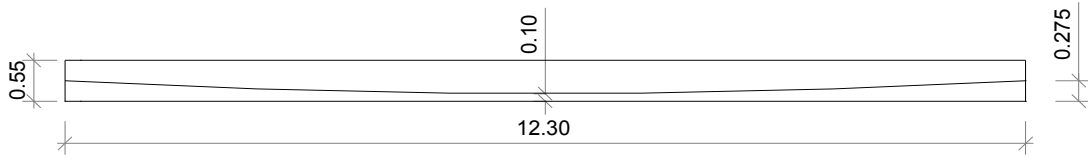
TRAÇADO DO CABO DE PRÉ-ESFORÇO (AUTOCAD)
